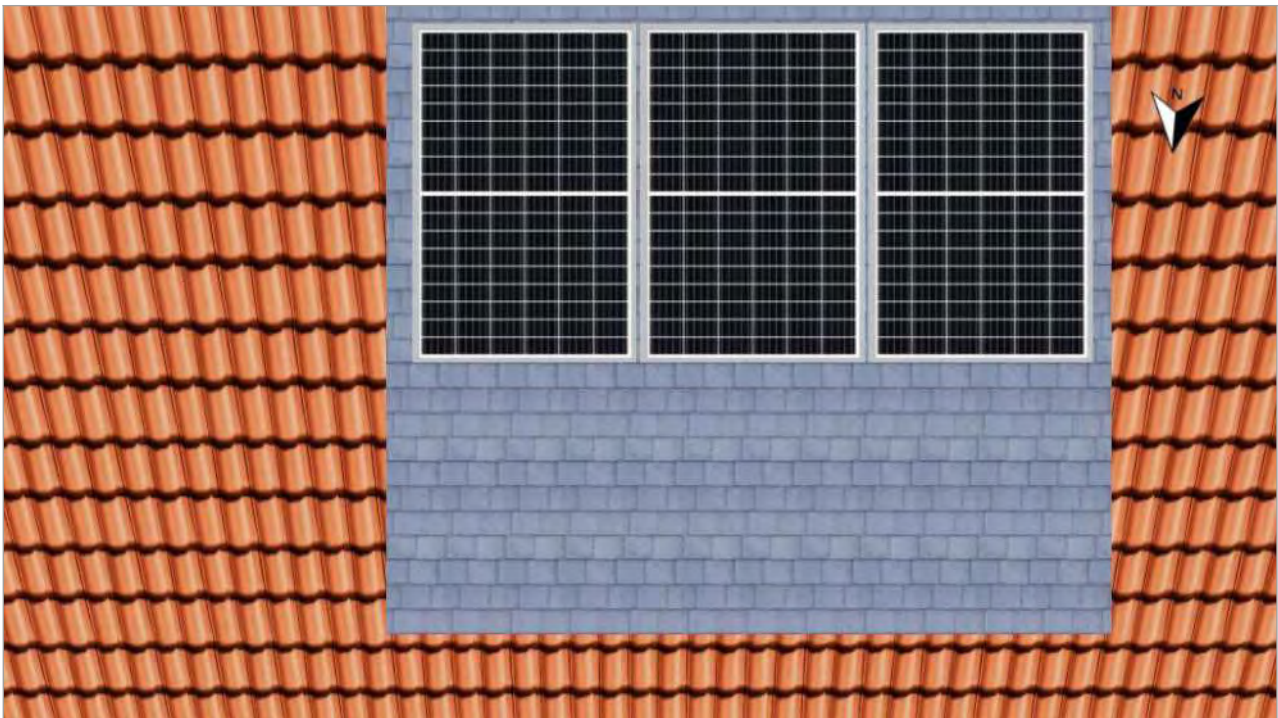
Modulfläche - Dachgaube 02-Dachfläche Nord
